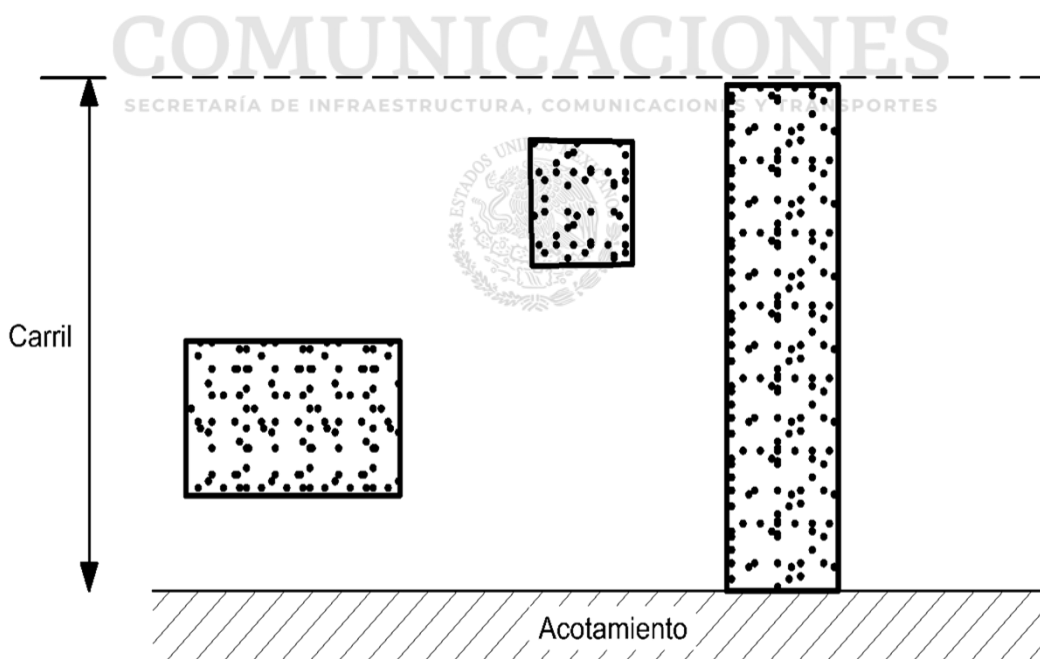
Esquema del deterioro “baches reparados” (vista en planta)
